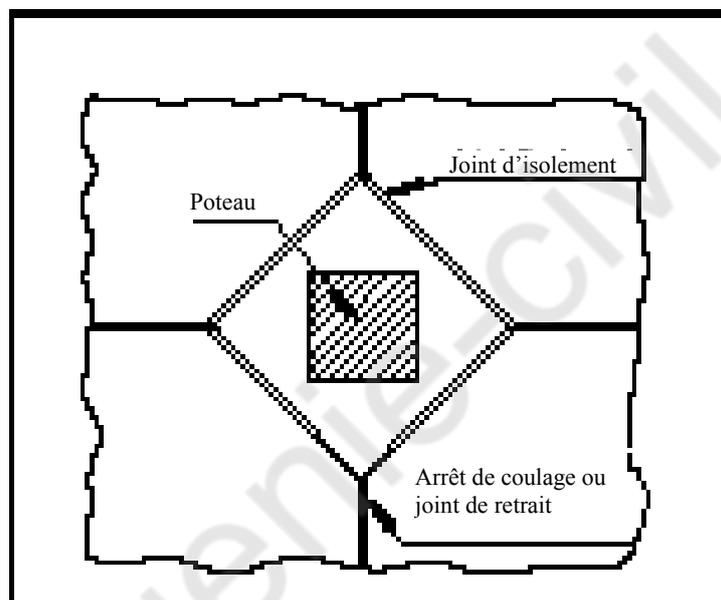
Exemple de joint d'isolement autour d'un poteau
